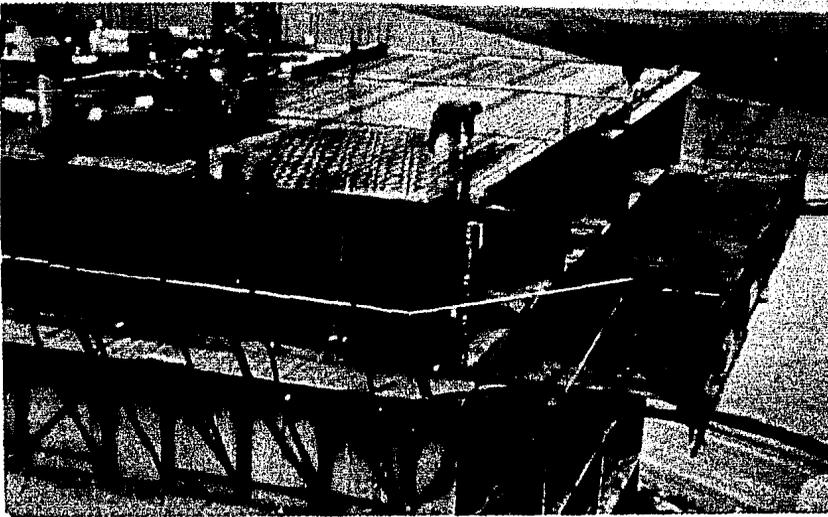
Armado en la losa a base de malla electrosoldada, una vez concluido el cimbrado.
